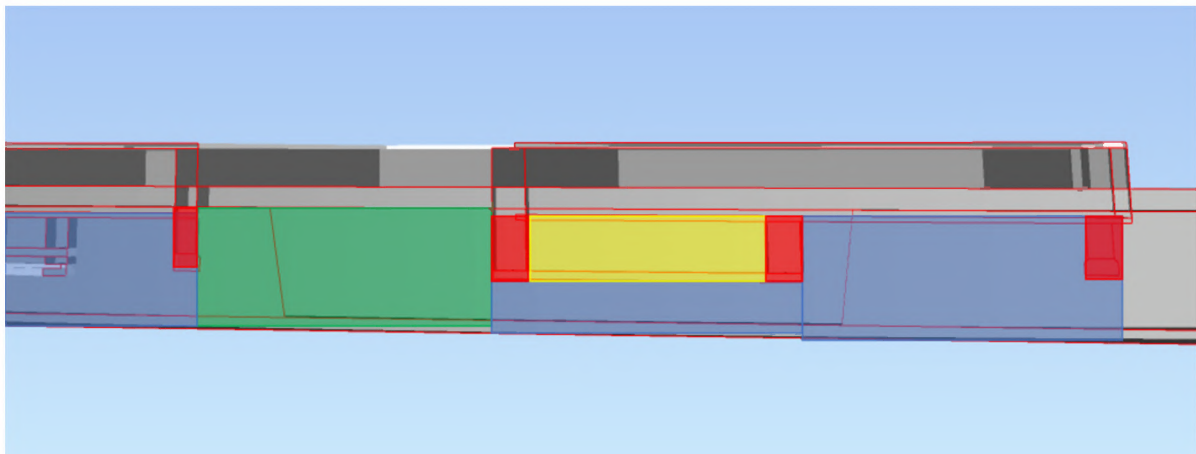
Schnitt B – B Westwand Tunnel (Süa)
